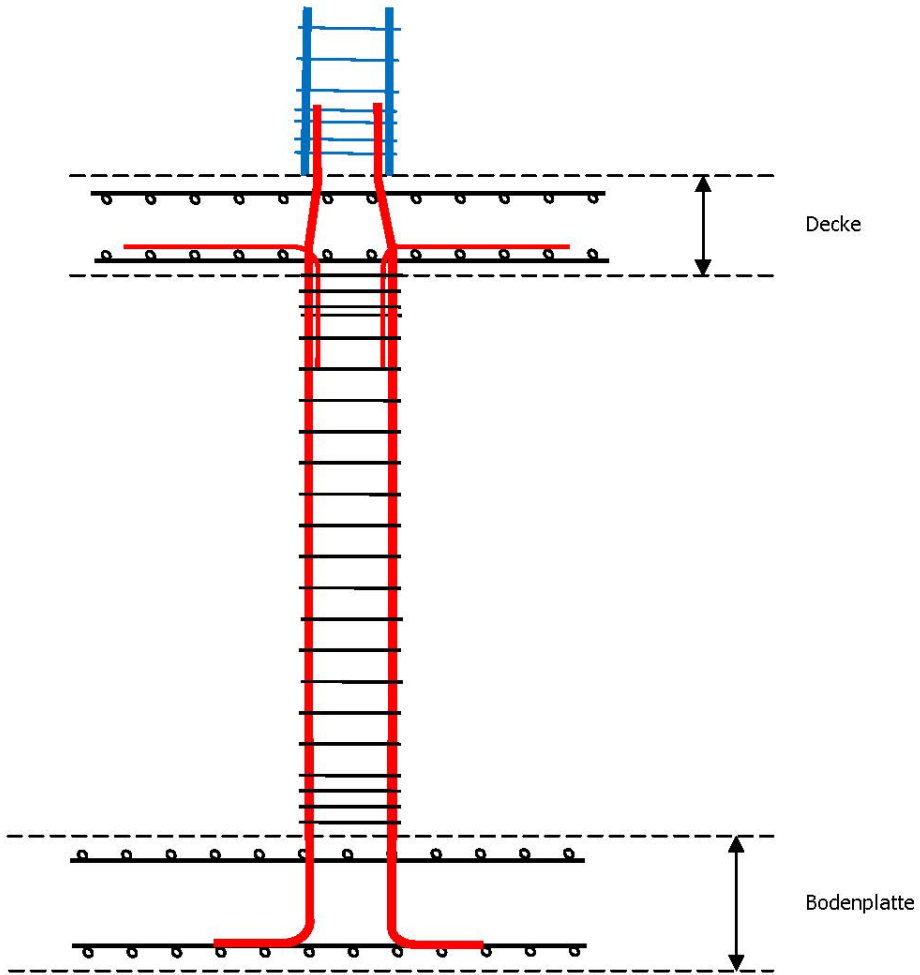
Vorschlag einer Planung über mehrere Ebenen
